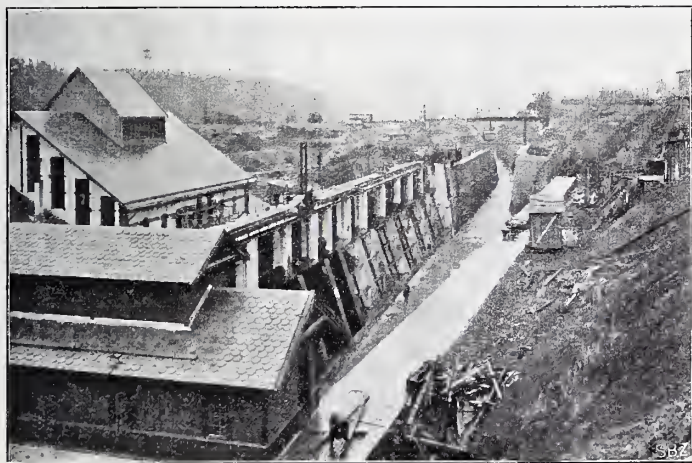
Zulaufkanal mit den Einlassschützen am Maschinenhause.
